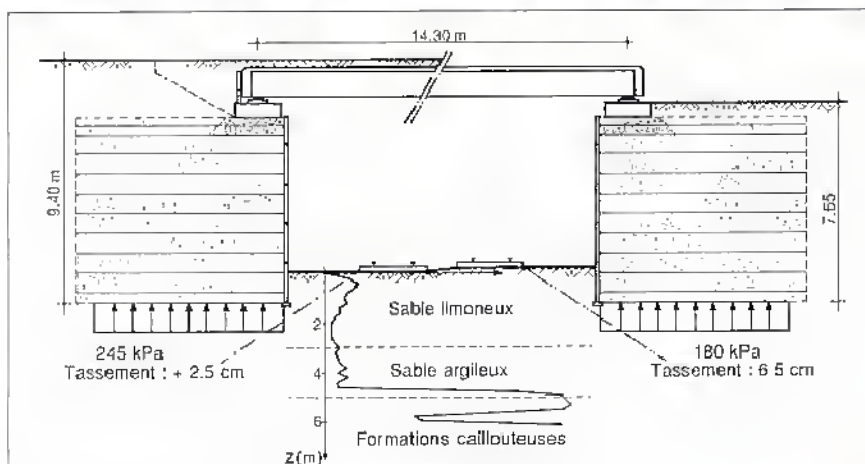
Pont d'Antoing. Consolidation du sol de fondation.
